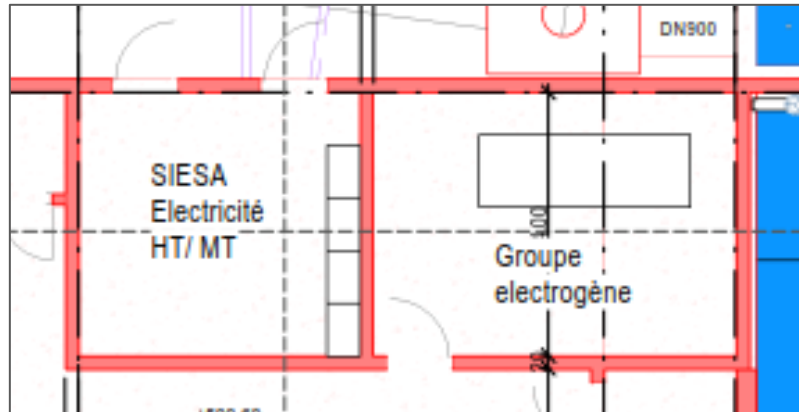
Plan d'installation des locaux électriques (moyenne tension)
